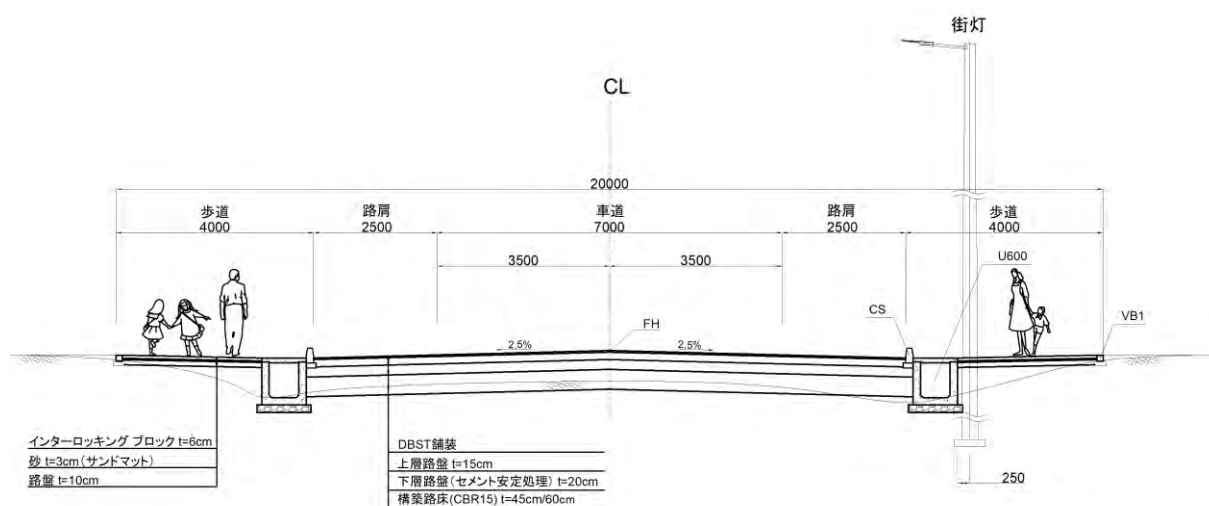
国道（B級国道）（ユンベタウン区間） 標準横断面図
